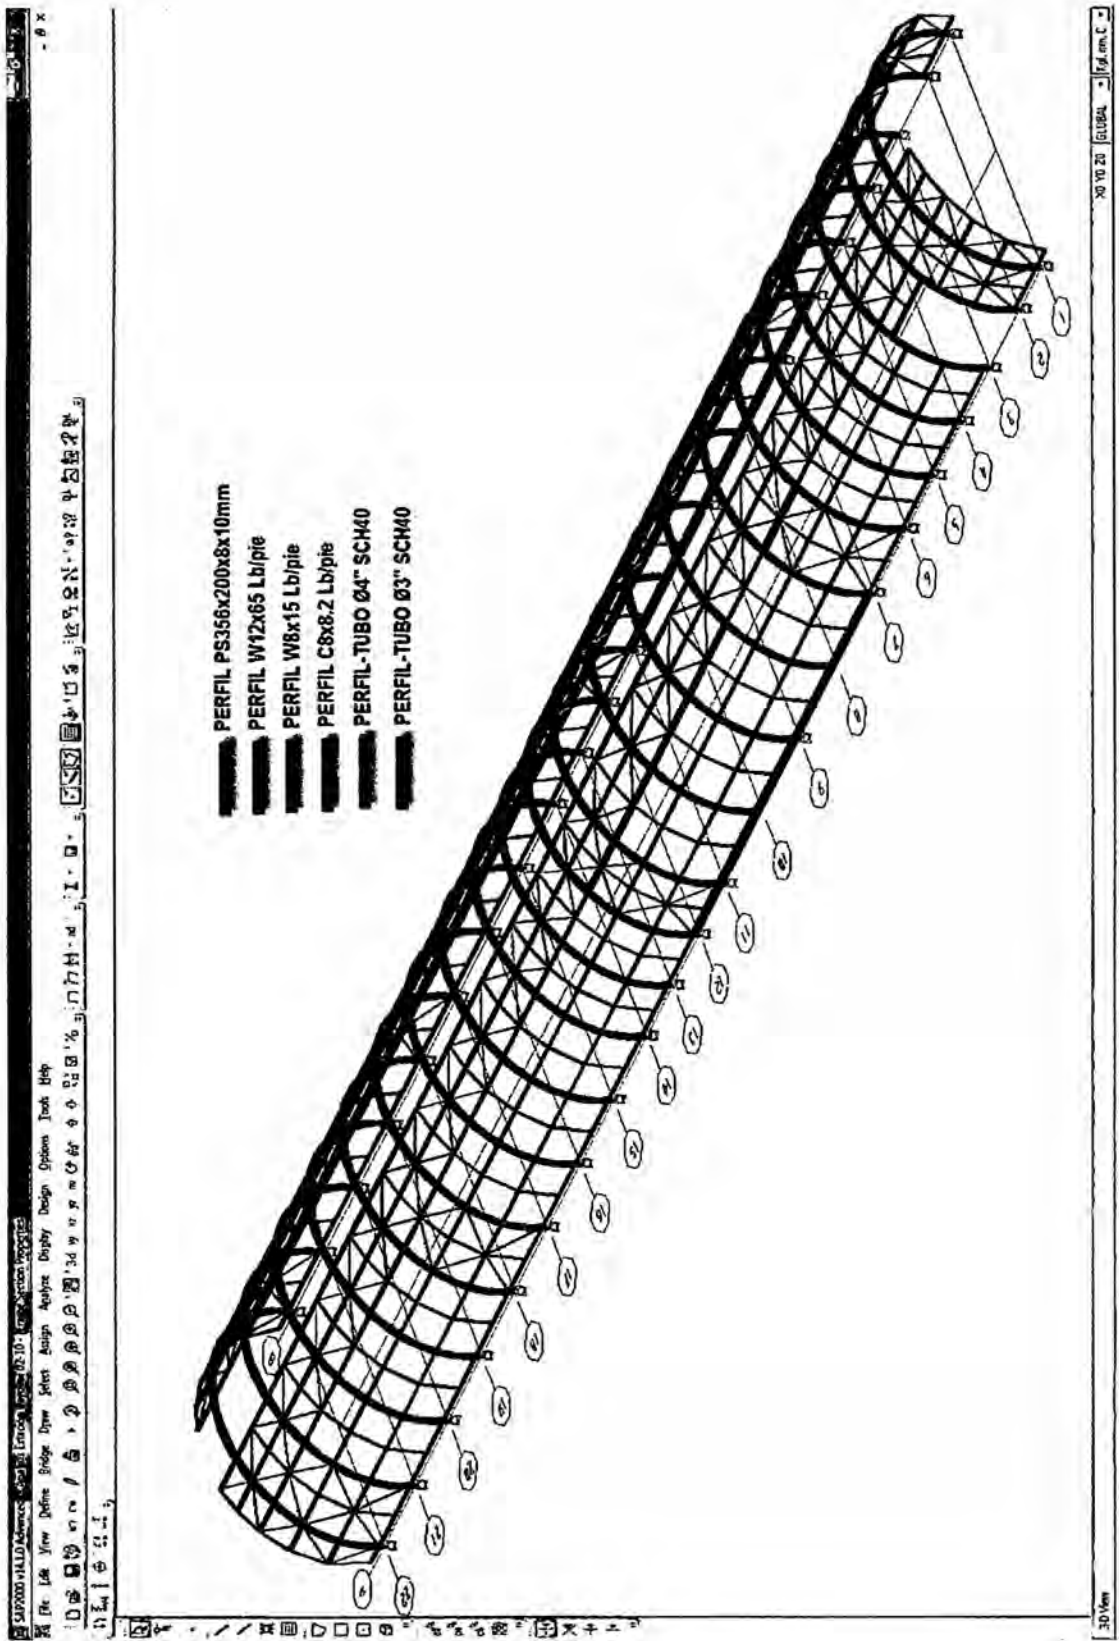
Vista 3D -Cubierta de Andén con Perfiles (Fuente: SAP 2000)
